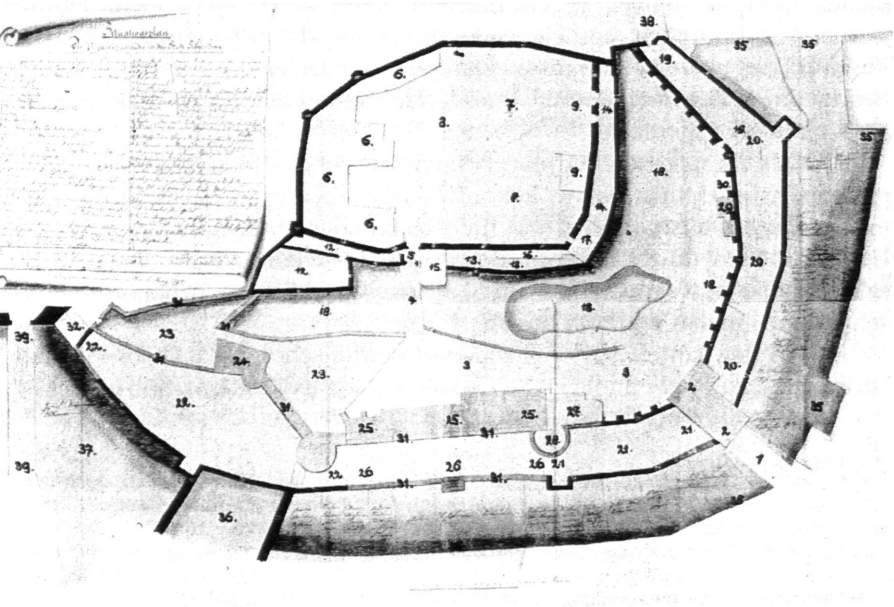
Grundriss des Scharding Schlosses nach B. Aichinger.
